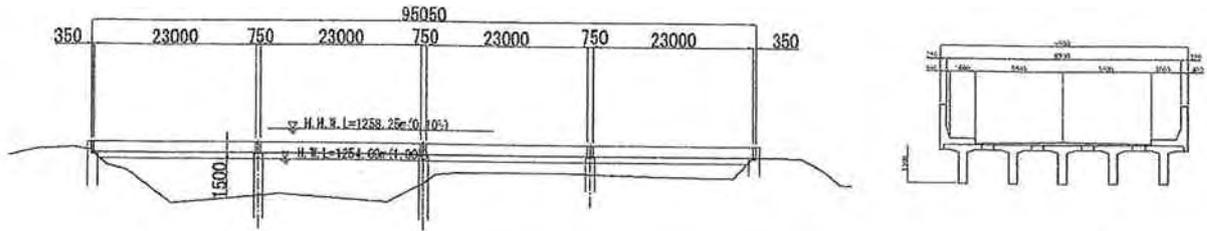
Plan du Pont à poutres en T simple avec système de précontrainte par tension après bétonnage (post-tension, longueur de travée : 23,0 m)
